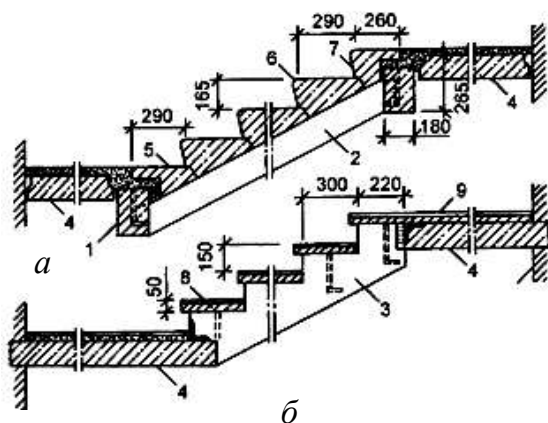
Сходи з дрібнорозмірних елементів по залізобетонних косоурах: а – косоури спираються на поперечні стіни; б – косоури складчастої форми спираються на площадки; 1 – підкосоурна балка; 2, 3 – косоури; 4 – залізобетонні площадки; 5, 7 – нижня і верхня фризиви сходинок; 6 – рядова сходинок; 8 – залізобетонна плита-проступ
